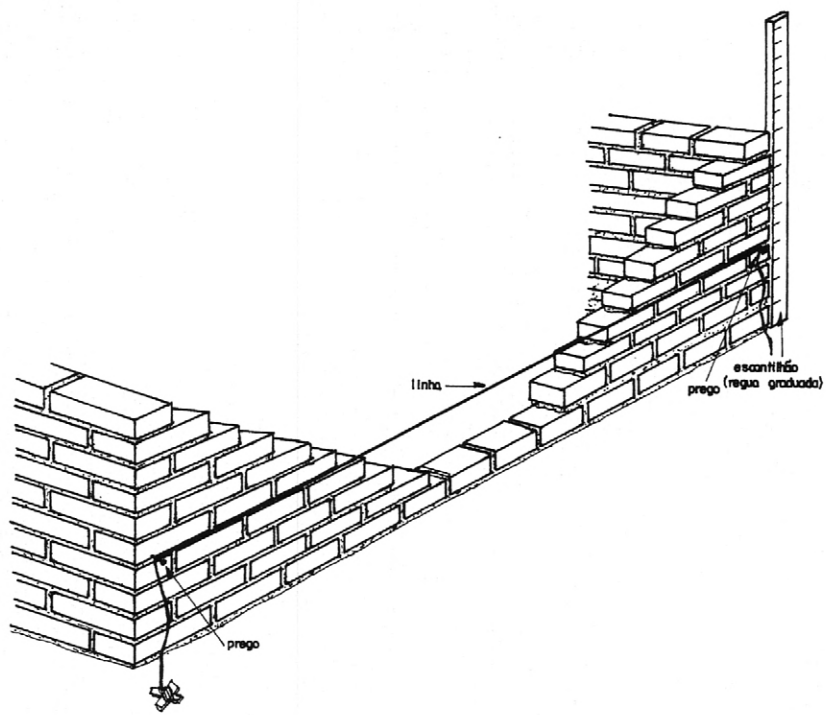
Detalhe do nivelamento da elevação da alvenaria.
